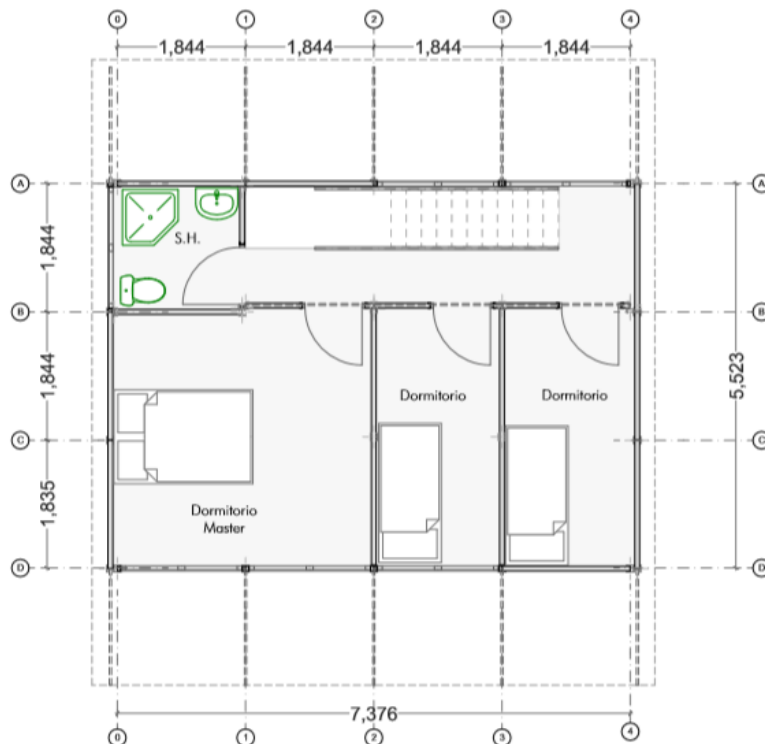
Plano arquitectónico de la planta alta de la vivienda de 2 plantas (Opción A)
